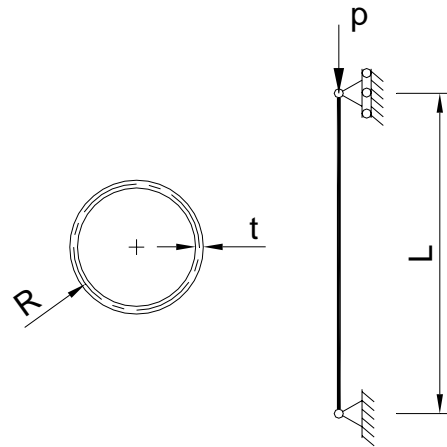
Tube de section creuse circulaire en compression axiale uniforme.
